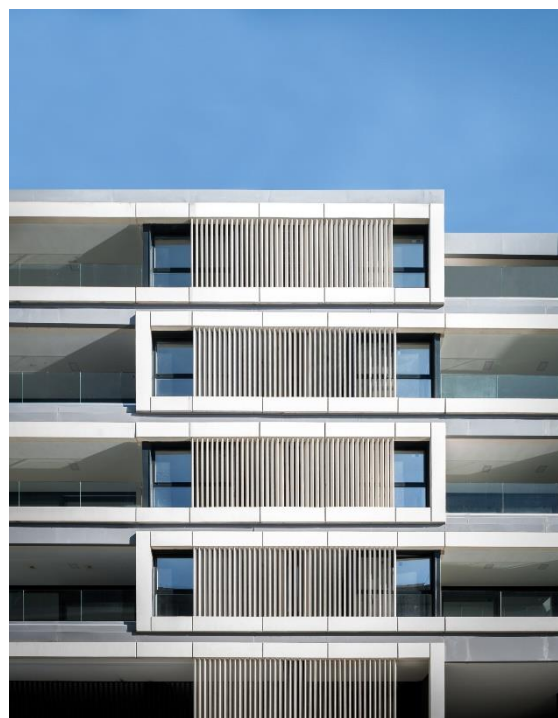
Instalación de paneles prefabricados de INDAGSA
